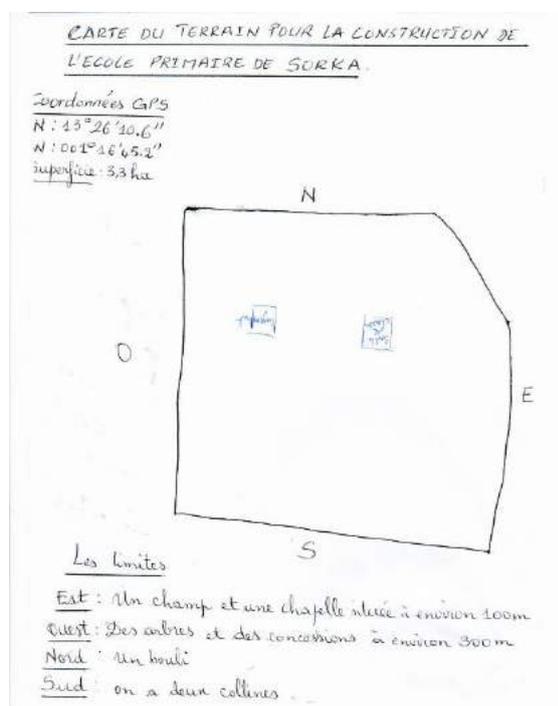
Planta de situación. Fuente: OCADES (Contraparte en Soarka)
